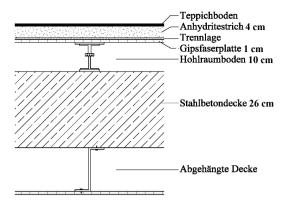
Deckenaufbau (Decke über EG, 1. und 2. OG)
